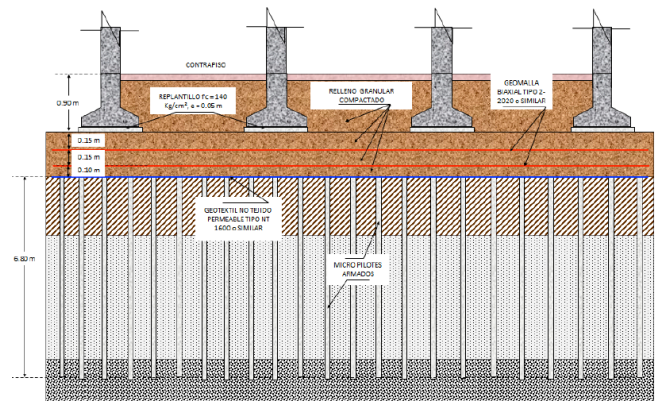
Esquema constructivo del tratamiento de cimentación para construir un bloque de suelo reforzado.
